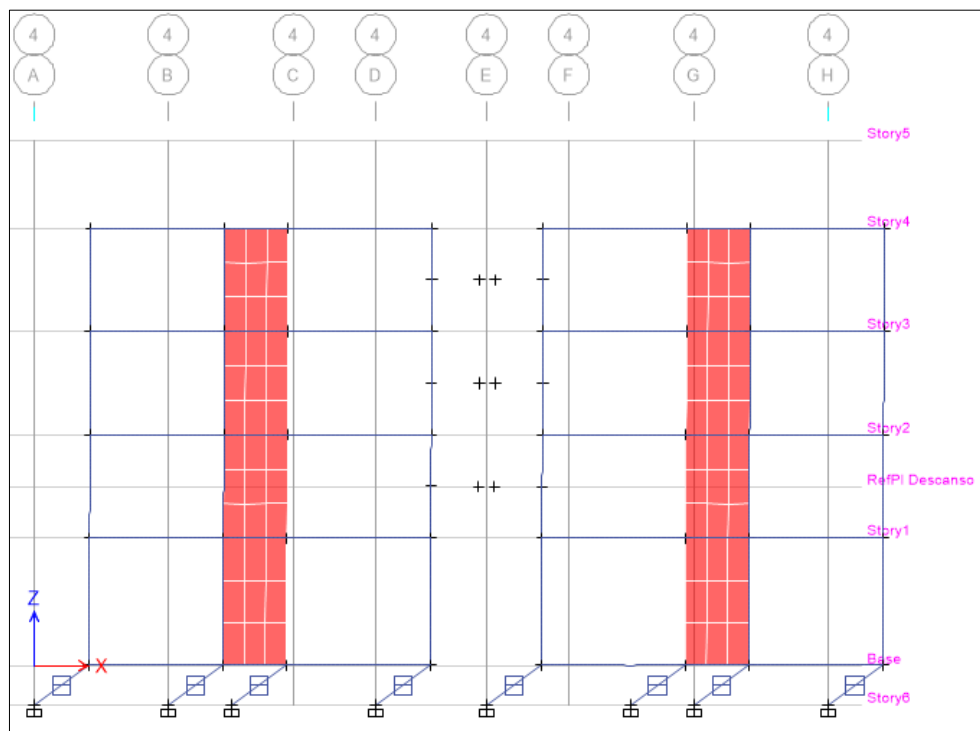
Desplazamiento de la estructura aislada en la dirección X
